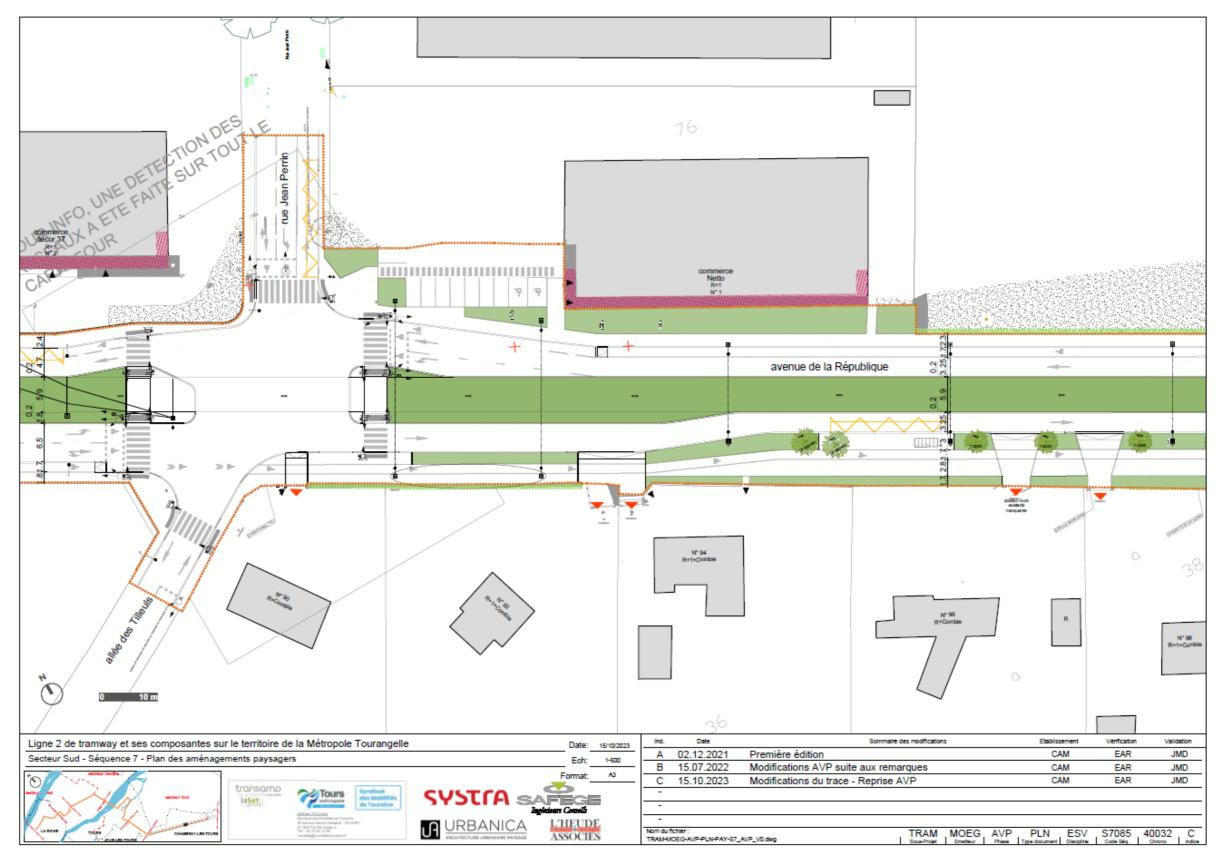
plan masse de localisation des arbres à abattre sur avenue de la République – Section 3 (planche 13)
